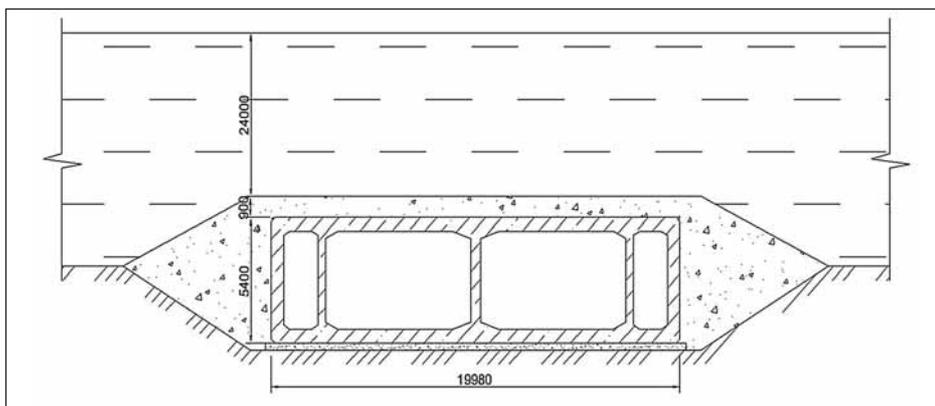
Поперечное сечение опускной секции тоннеля Тху Тхием
